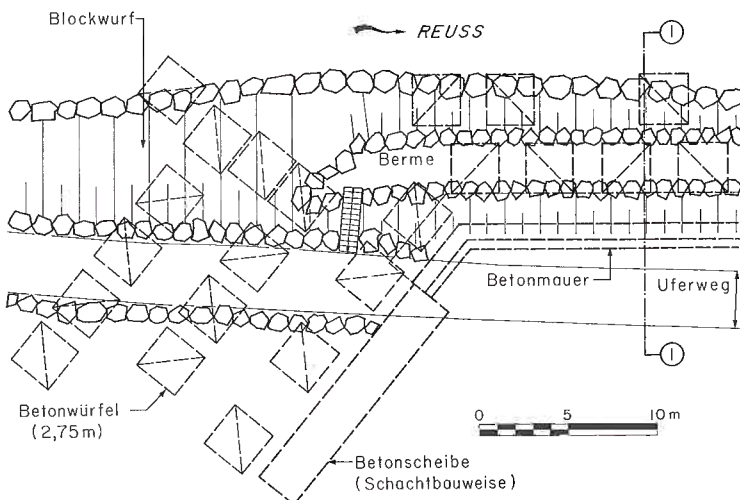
Hauptschutzelement B: Einbindung der überdeckten Betonmauer mit einer Betonscheibe in die Uferböschung der Kantonsstrasse. Sekundärer Blockwurf und diagonal halbierte Betonwürfel (Kantenlänge 2,75 m).
